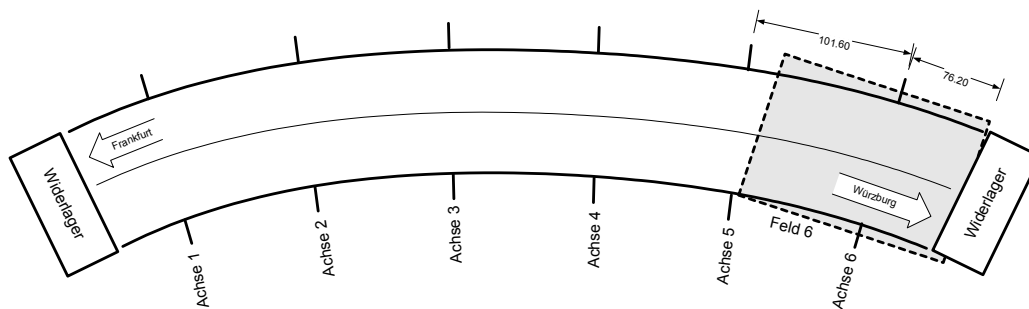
Grundriss des Gesamtaufbaus der Brücke
